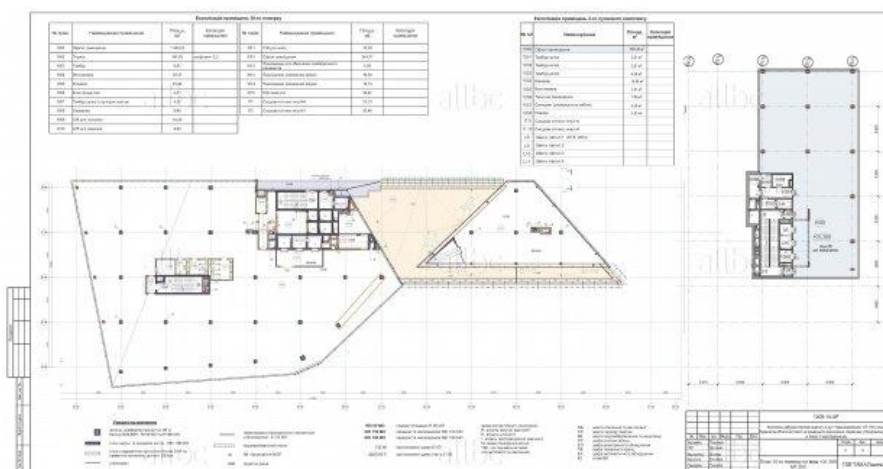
Планування 10-ого поверху БЦ Магнет [16]
